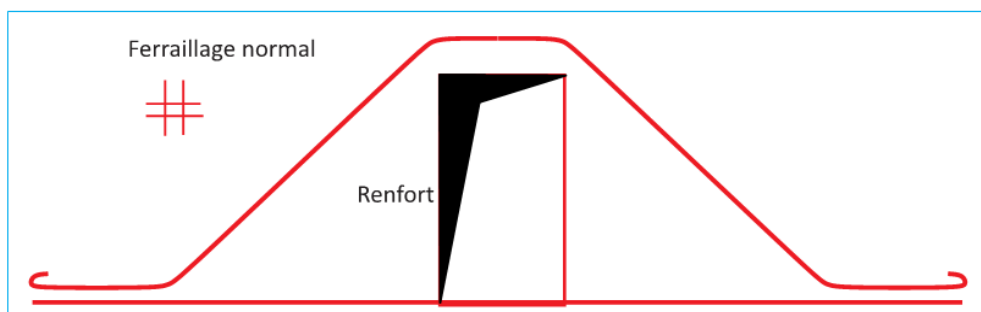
Exemple de ferrailage d'un mur avec renfort d'ouverture
